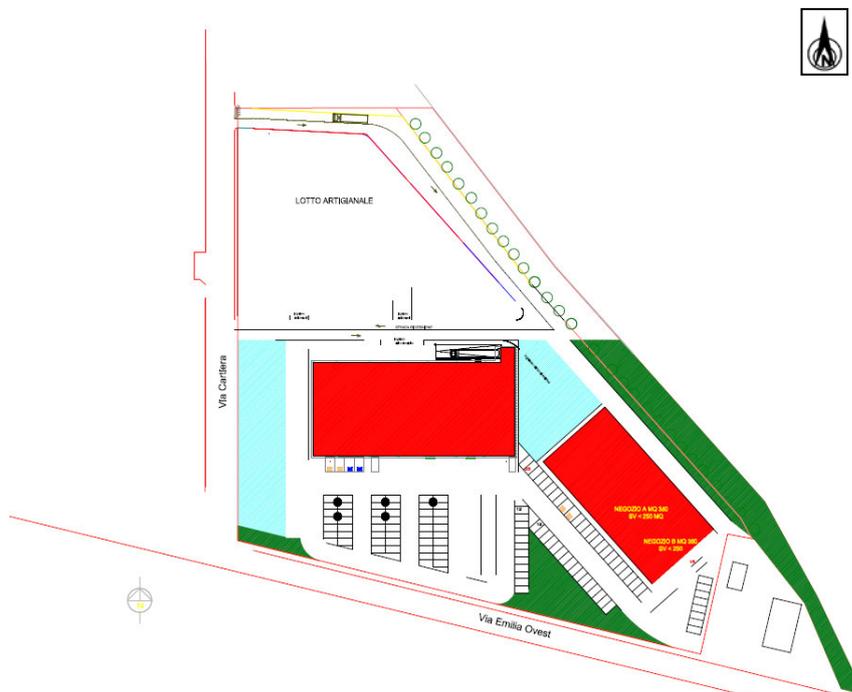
Planivolumetrico di progetto del POC.
